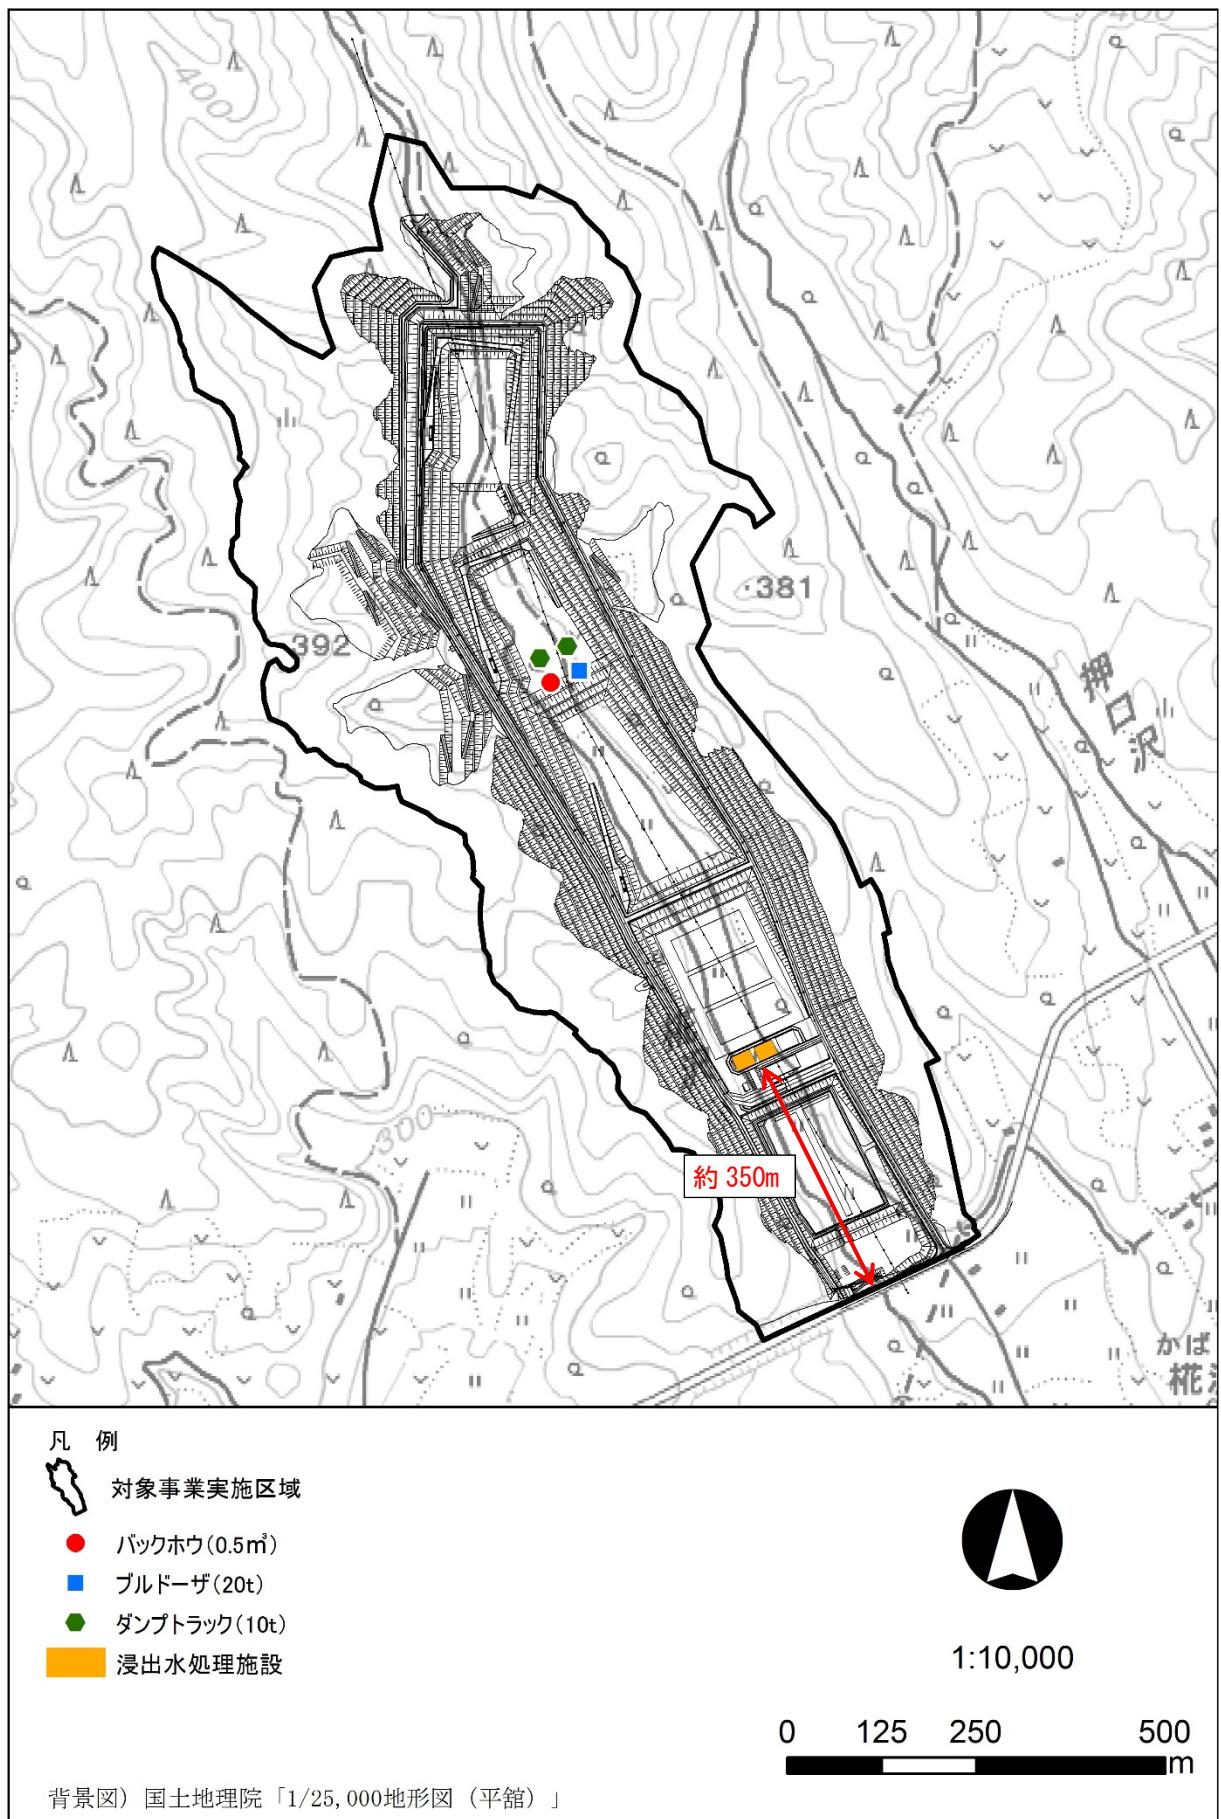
埋立・覆土用機械及び浸出水処理施設の配置図（Ⅱ期）
